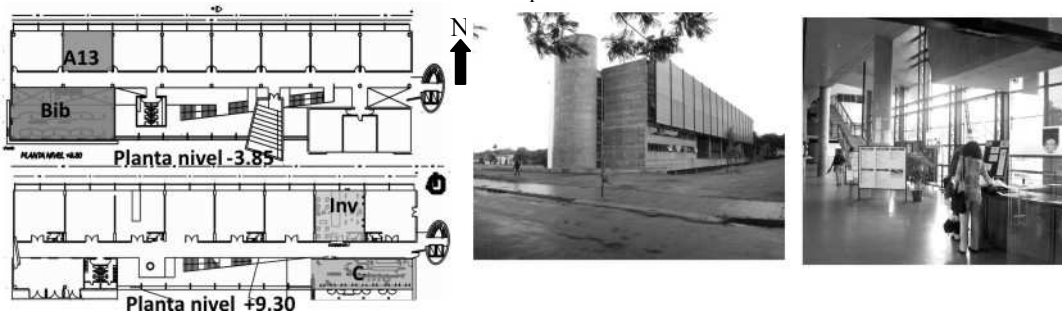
Plantas del edificio con la ubicación de locales estudiados y vistas de la fachada Norte y del atrio al sur.
